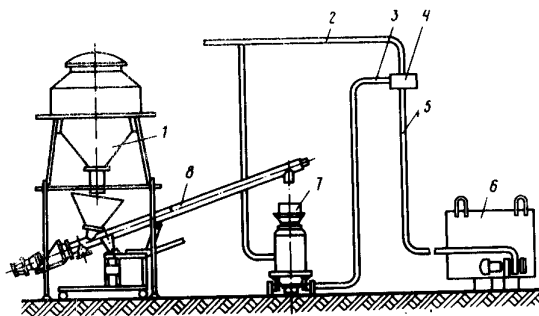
Схема установки конструкції ЦНИИОМТП
